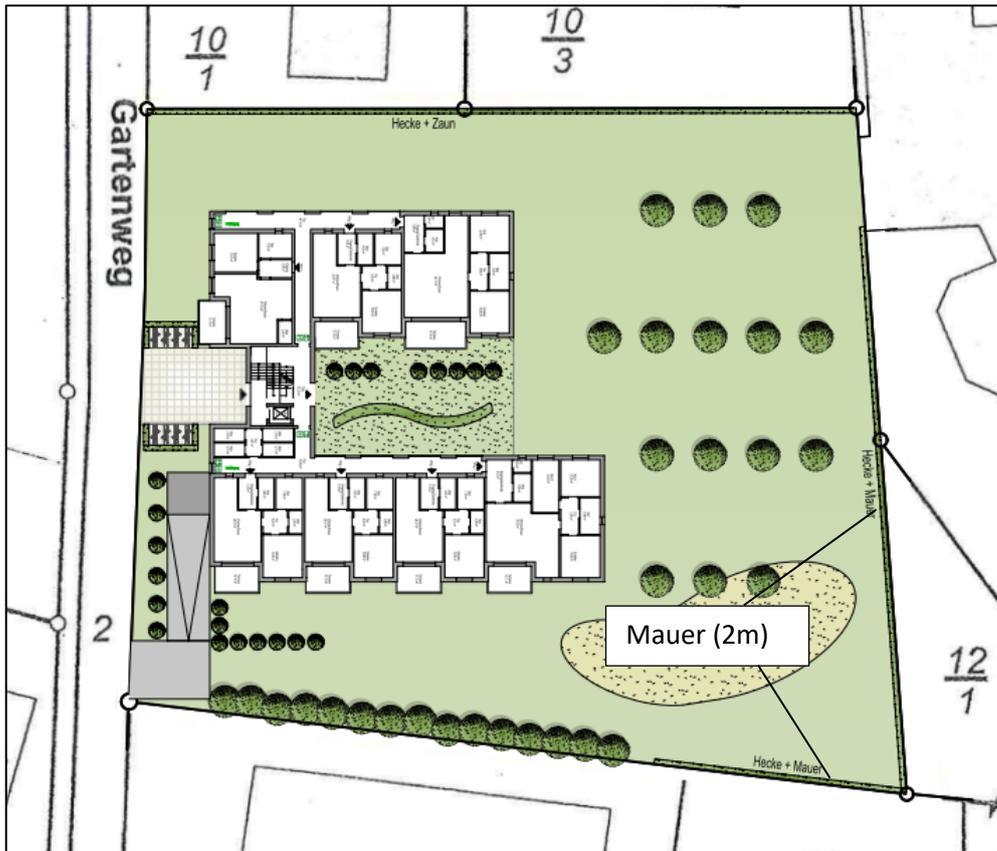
Lageplan Mehrfamilienhaus Gartenweg
